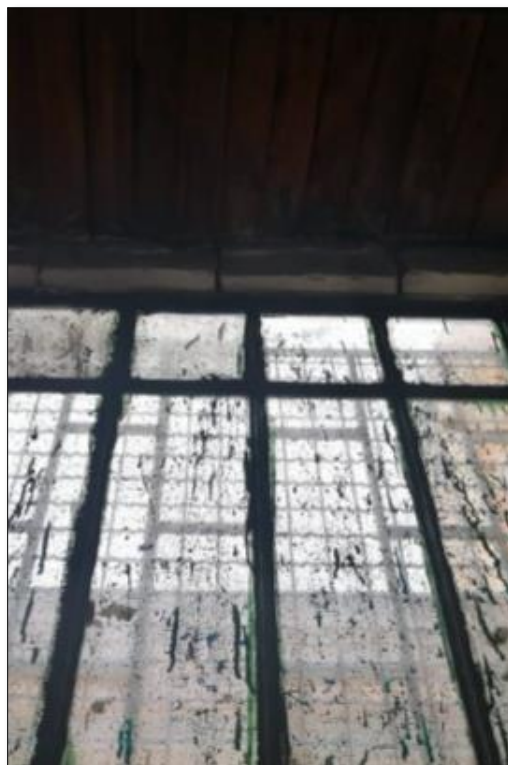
Vista de taponamiento parcial del vano de fachada y cambio de ventanería en el E 103
